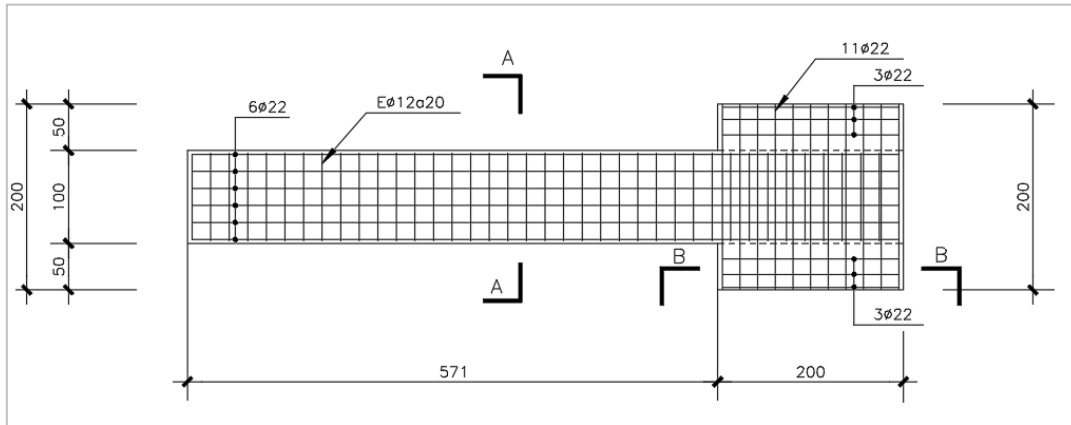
Detallamiento en planta zapata, ESC: 1:50.
